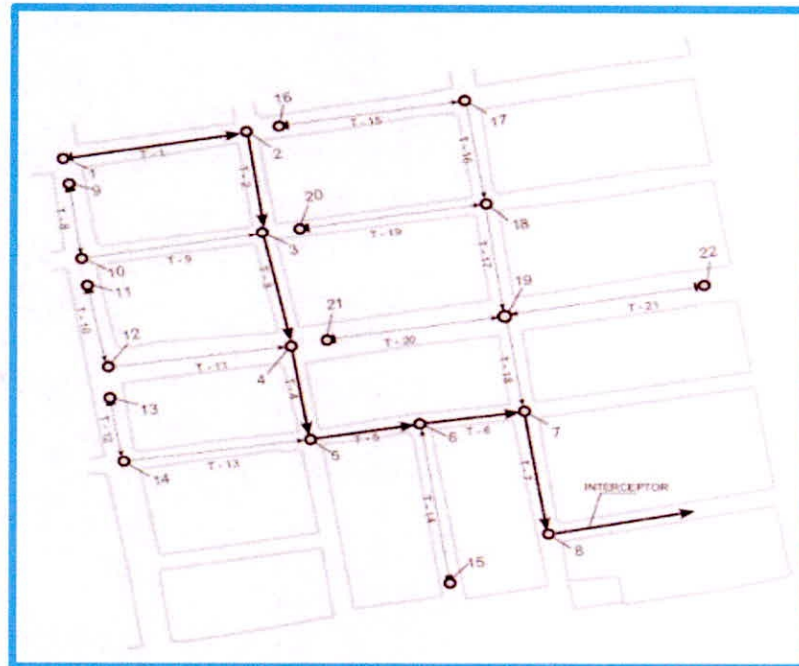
Esquema de una Red de Alcantarillado Sanitario
